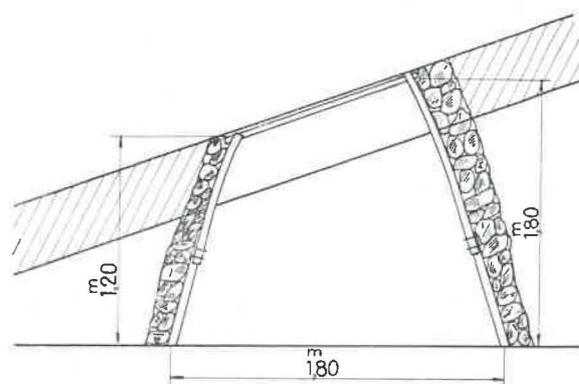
Schéma de la section de la fausse-voie et du soutènement en cadres trapézoïdaux coulissants.
